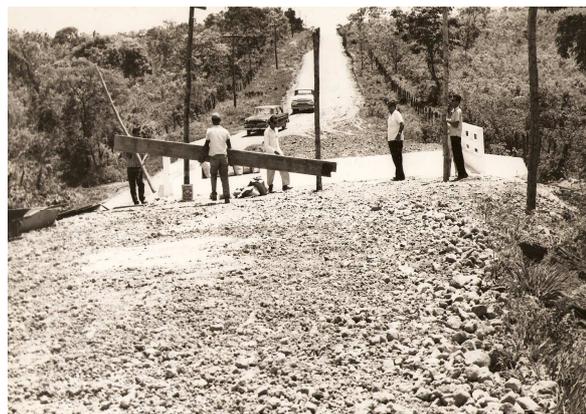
Construção de ponte sobre o Rio Caititu: Trecho da estrada Janaúba – Montes Claros.
